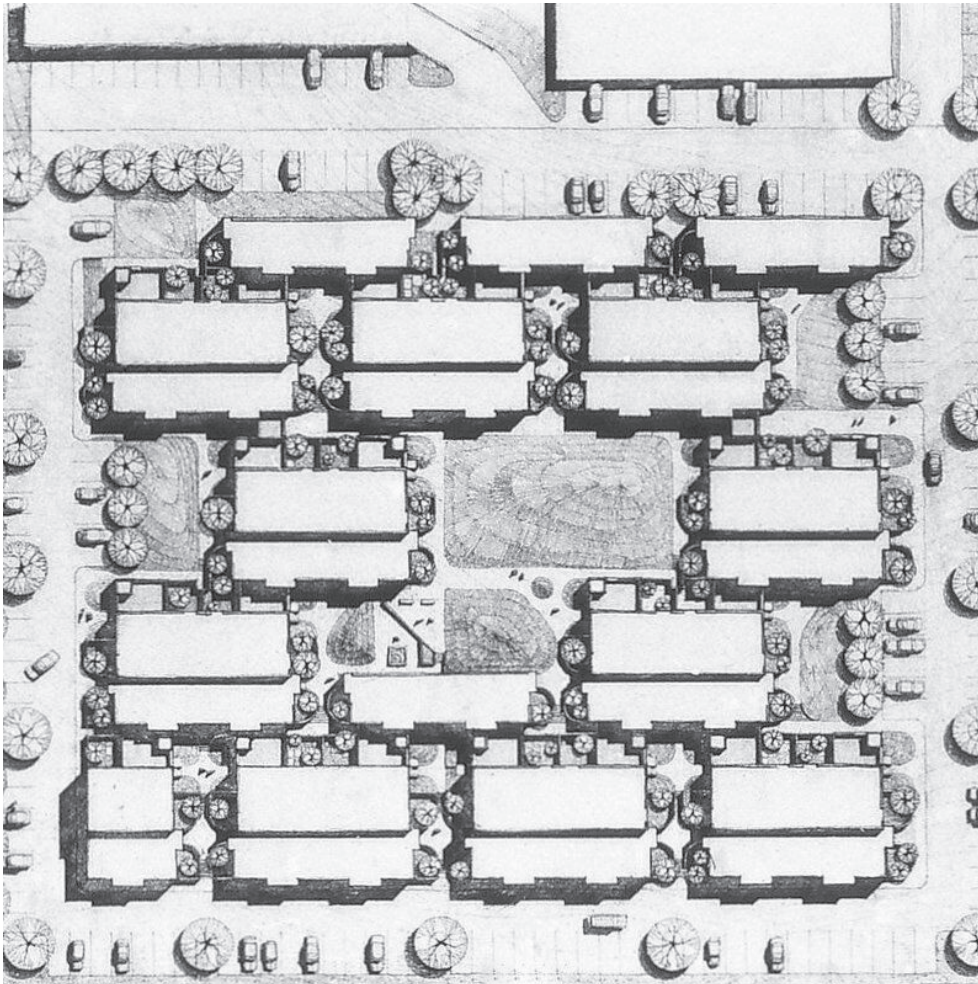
Plan du lotissement orienté vers le sud. Louis Sauer 1970
